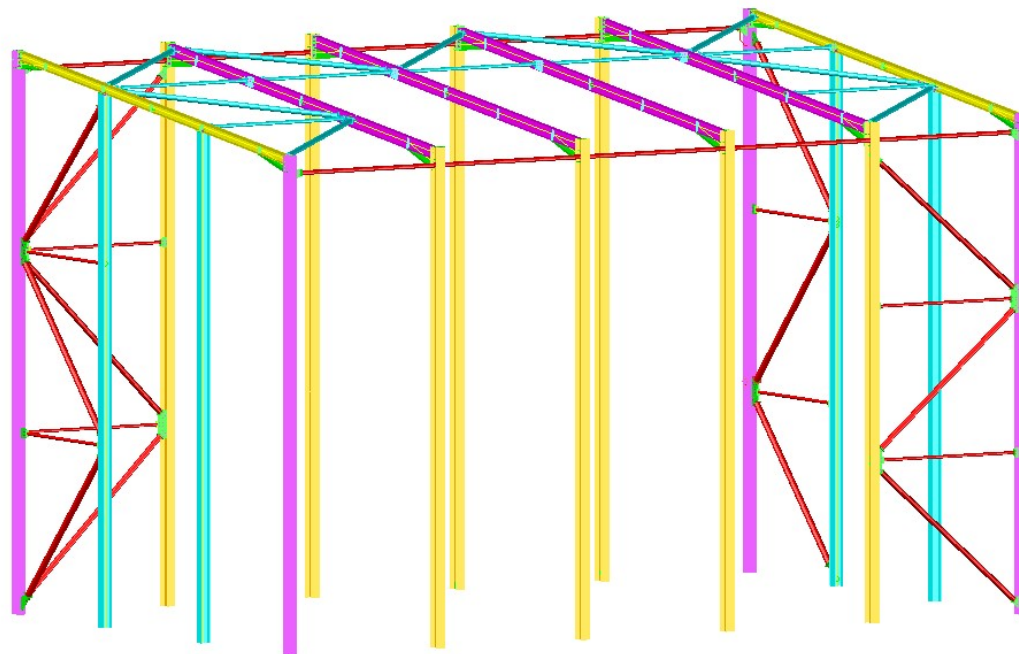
Vista geral 3D - Contraventamentos de fachada
